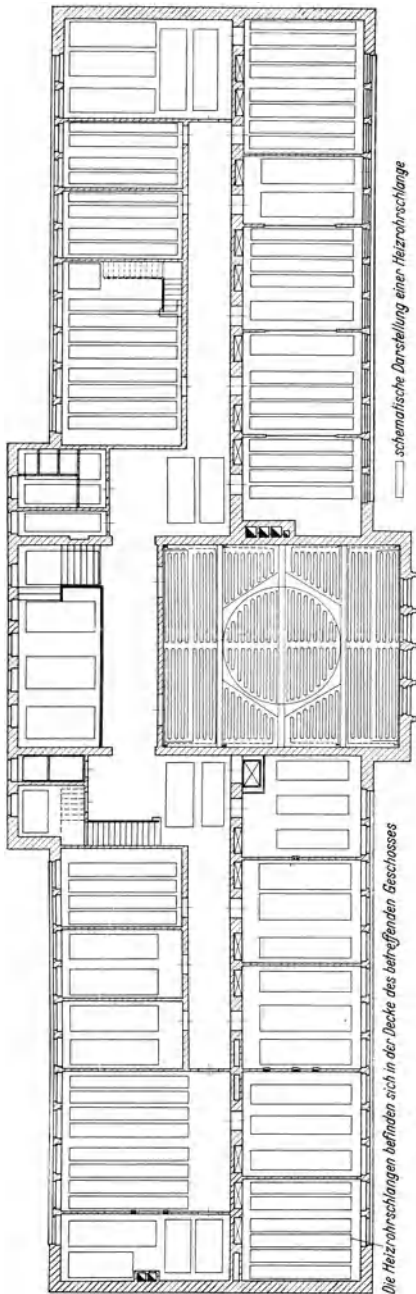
Ausgeführte Deckenstrahlungsheizung für das Forschungsinstitut eines industriellen Großbetriebes. Grundriß des 1. Obergeschosses.
